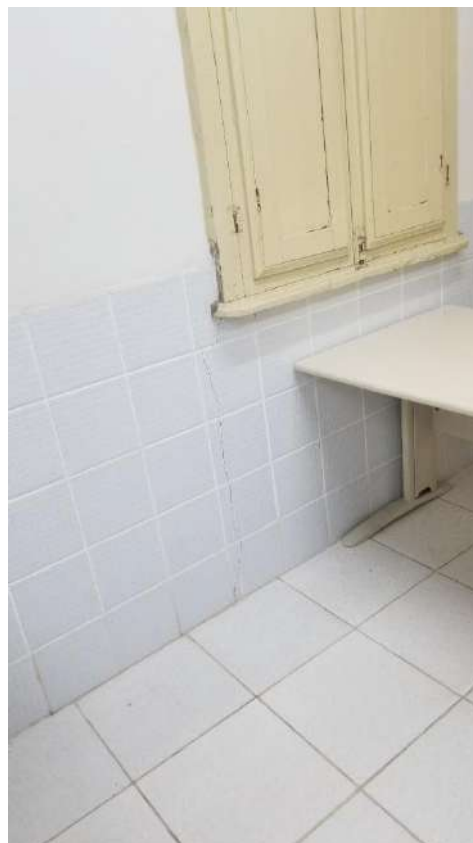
Fissura no revestimento abaixo da abertura
